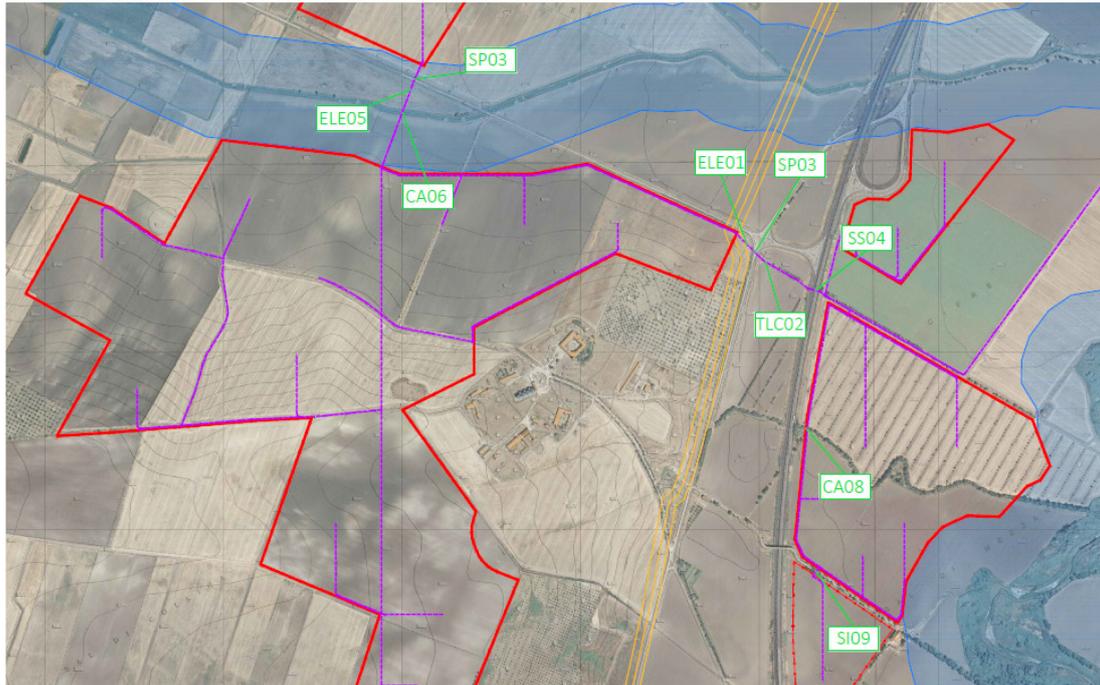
Individuazione delle Interferenze nell'area di installazione dell'impianto
